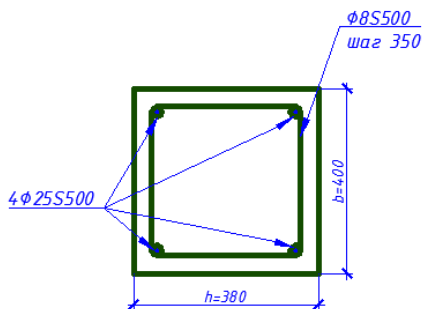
Размещение арматуры в поперечном сечении надкрановой части колонны
